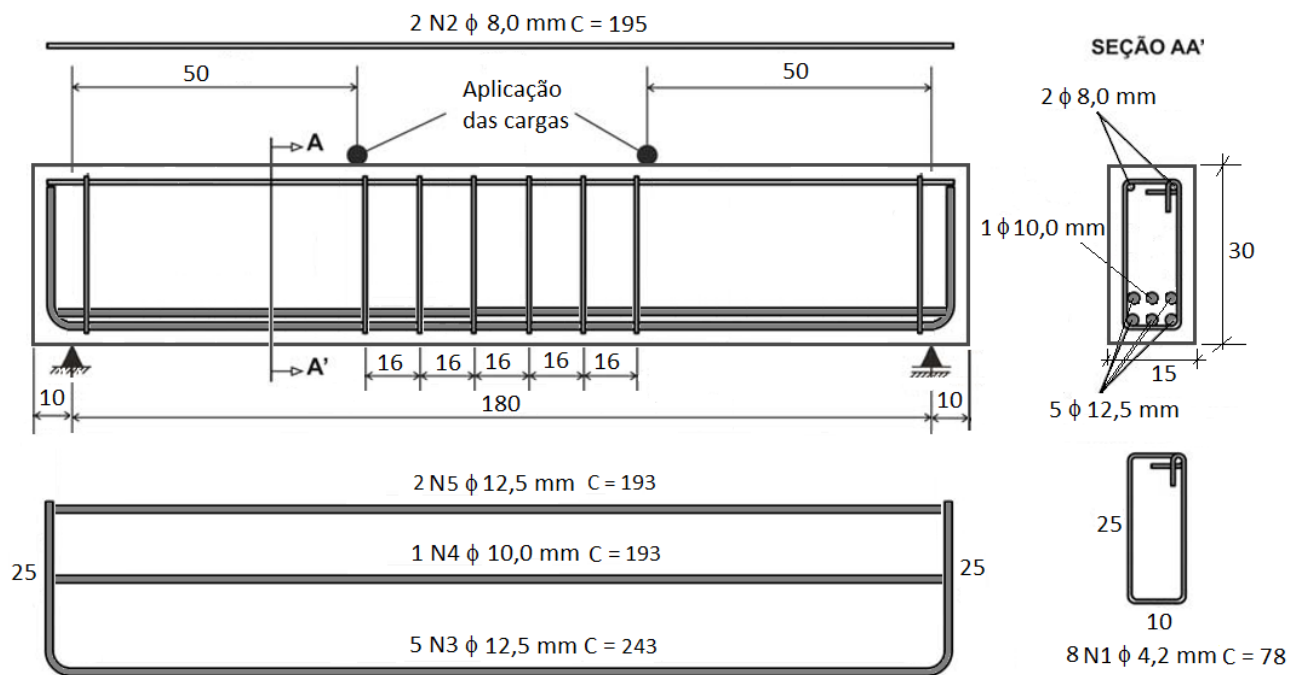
Esquema de detalhamento das armaduras das Vigas 2 para $a = 50,0$ cm, contas em centímetros.
